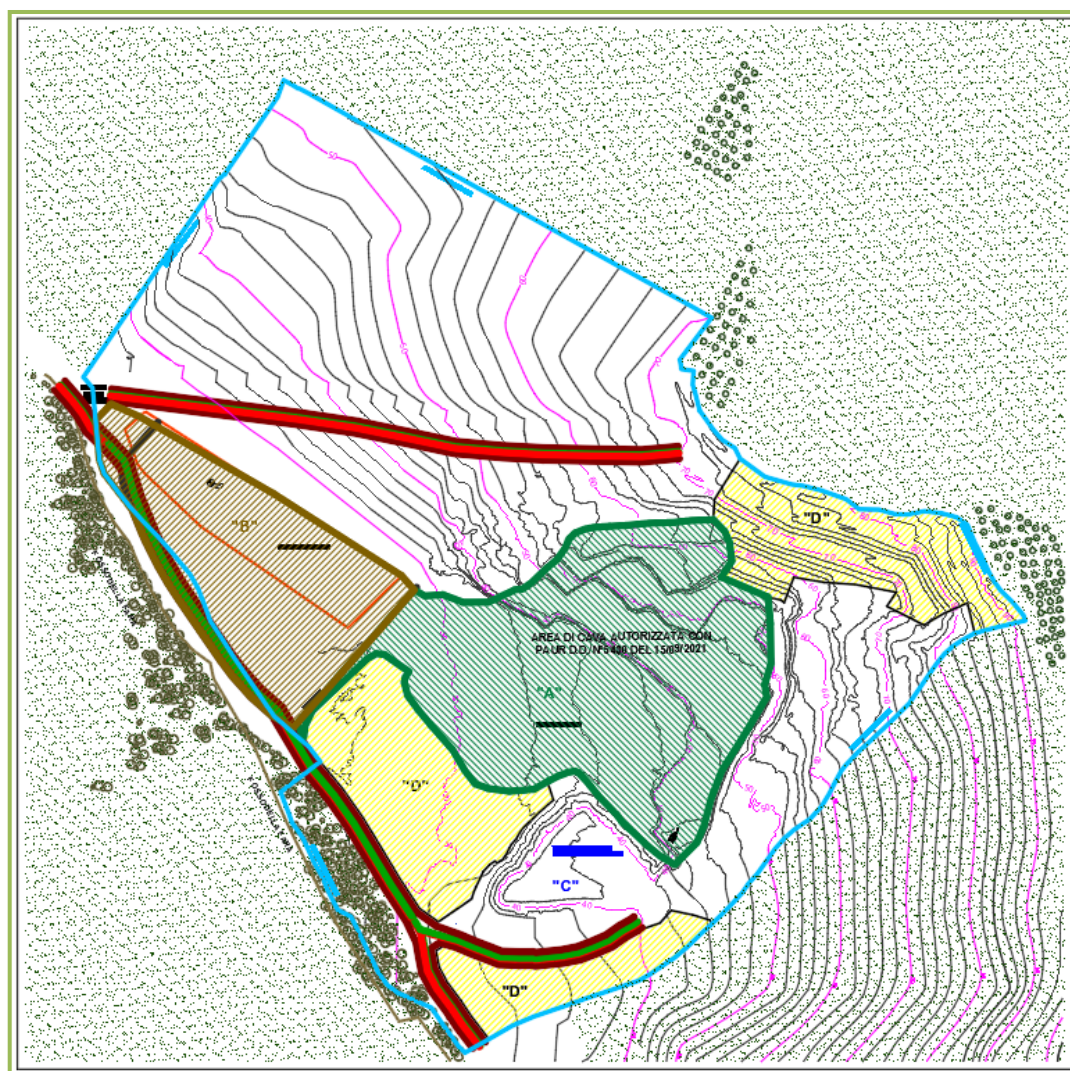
Planimetria con individuazione delle aree “A” - “B” - “C” - “D”.
